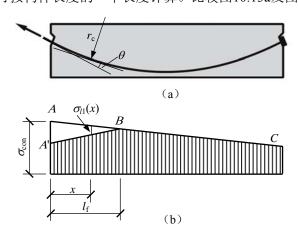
曲线形预应力钢筋因锚具变形和钢筋内缩引起的预应力损失 σ_{l1}
